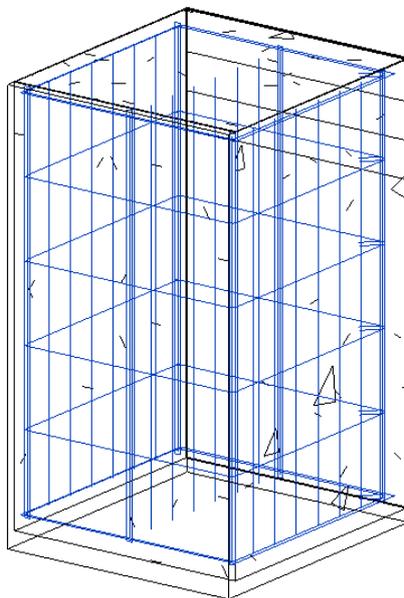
Пример моделирования арматурного каркаса в фундаментах
